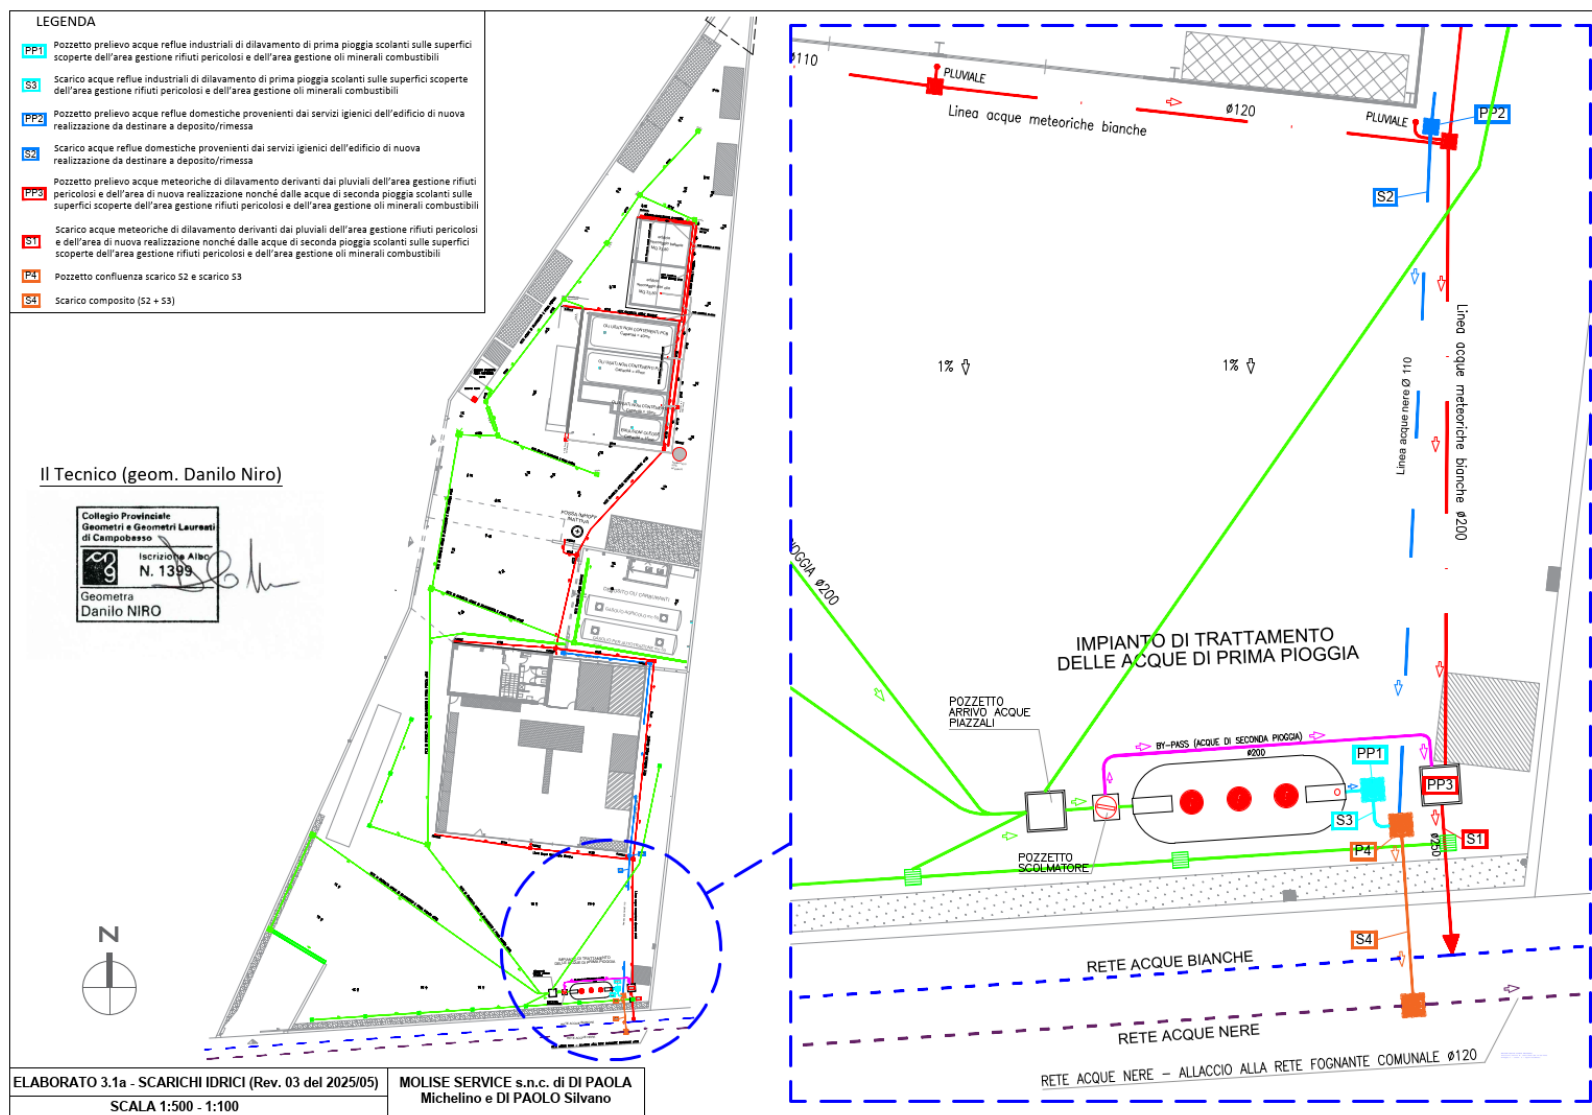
planimetria generale di stabilimento con indicazione dei punti di emissioni idrica: assetto "ante operam"
